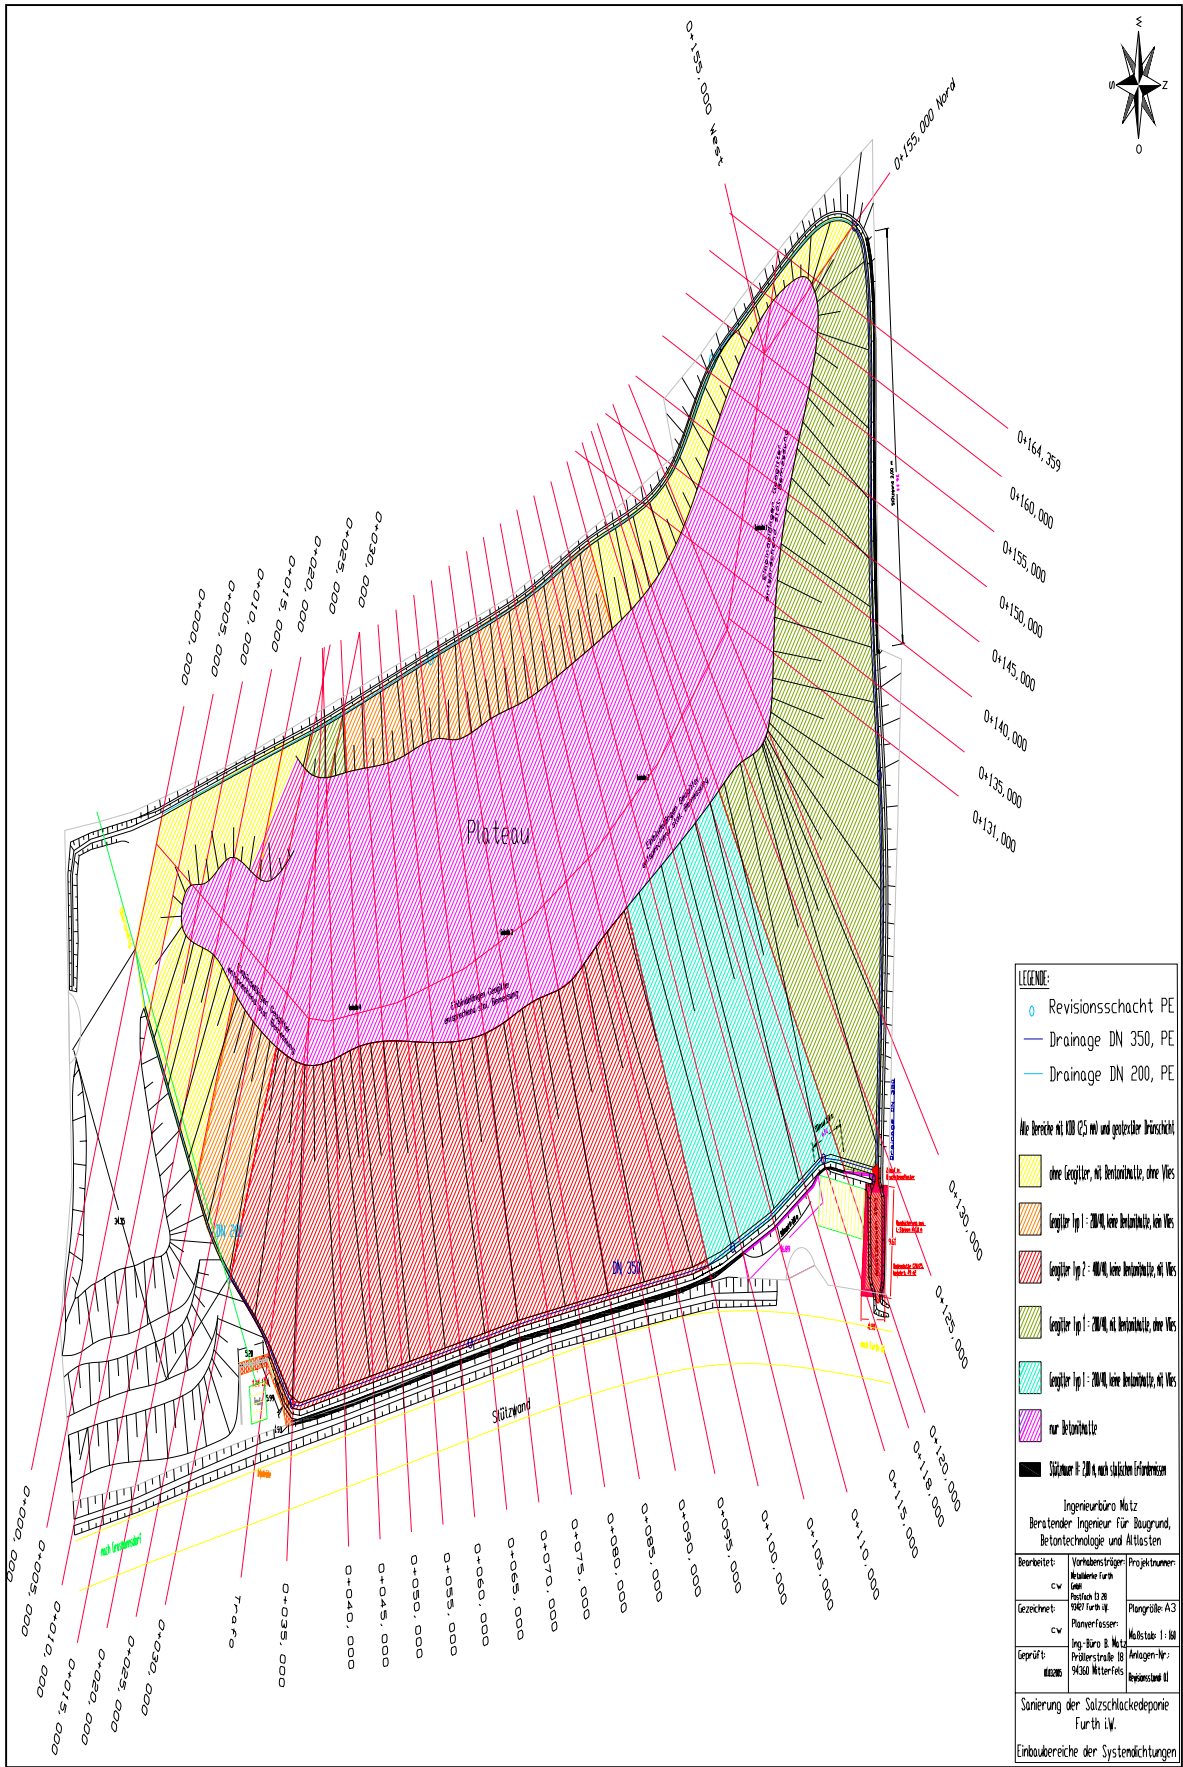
Lageplan zur Ausführung des Oberflächendichtungssystems
